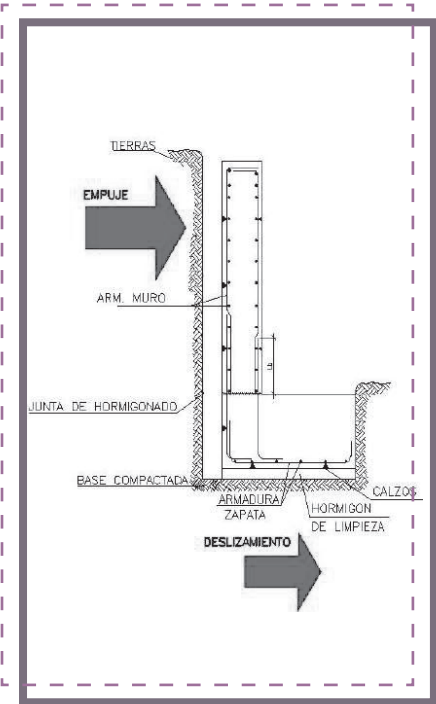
Esquema de las fisuras por deslizamiento del muro de contención.
